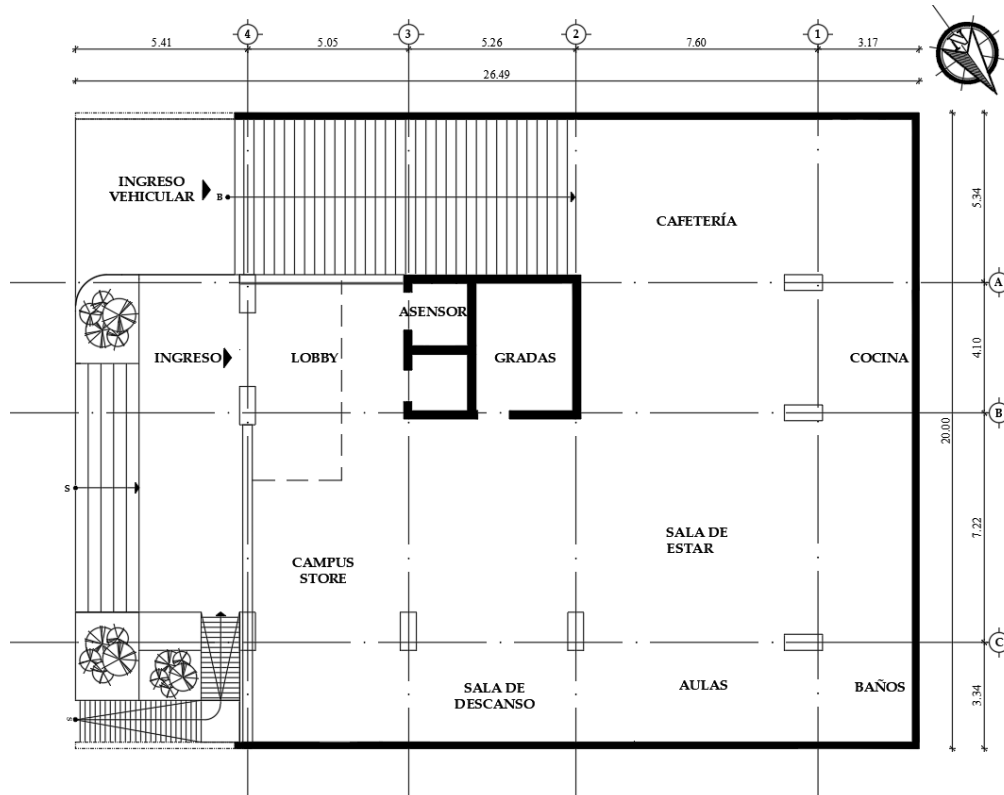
Planta baja, edificio Felipe Segovia Olmo.
